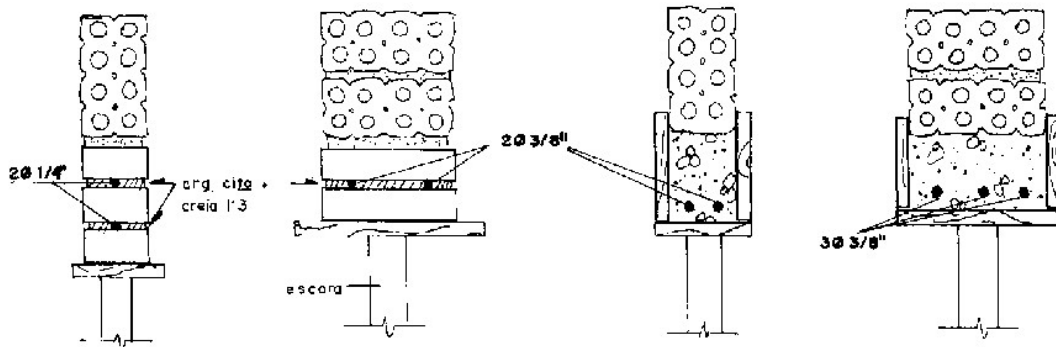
Vergas em alvenaria de tijolo furado para vãos até 1,00m e entre 1,00m e 2,00m.
